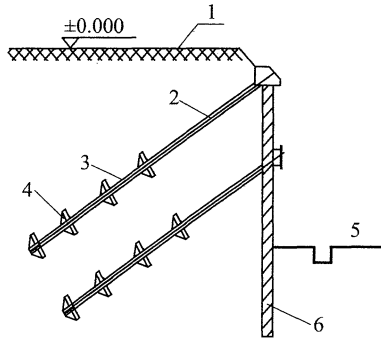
钢筋混凝土桩墙与多盘加筋水泥土锚体结构
